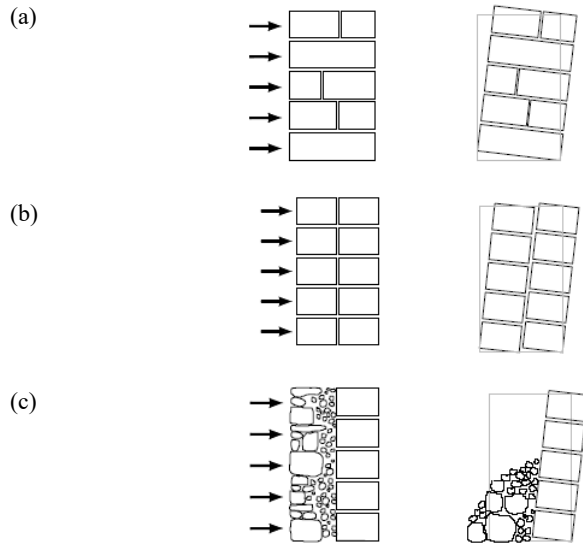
Coupes transversales de refends en maçonnerie [25] (a) Construction homogène, à parement unique ou *d'une imbrication suffisante*, (b) construction à parement double et (c) construction à parement double, où seul le parement externe est porteur, le parement interne n'a pas de fonction porteuse.
